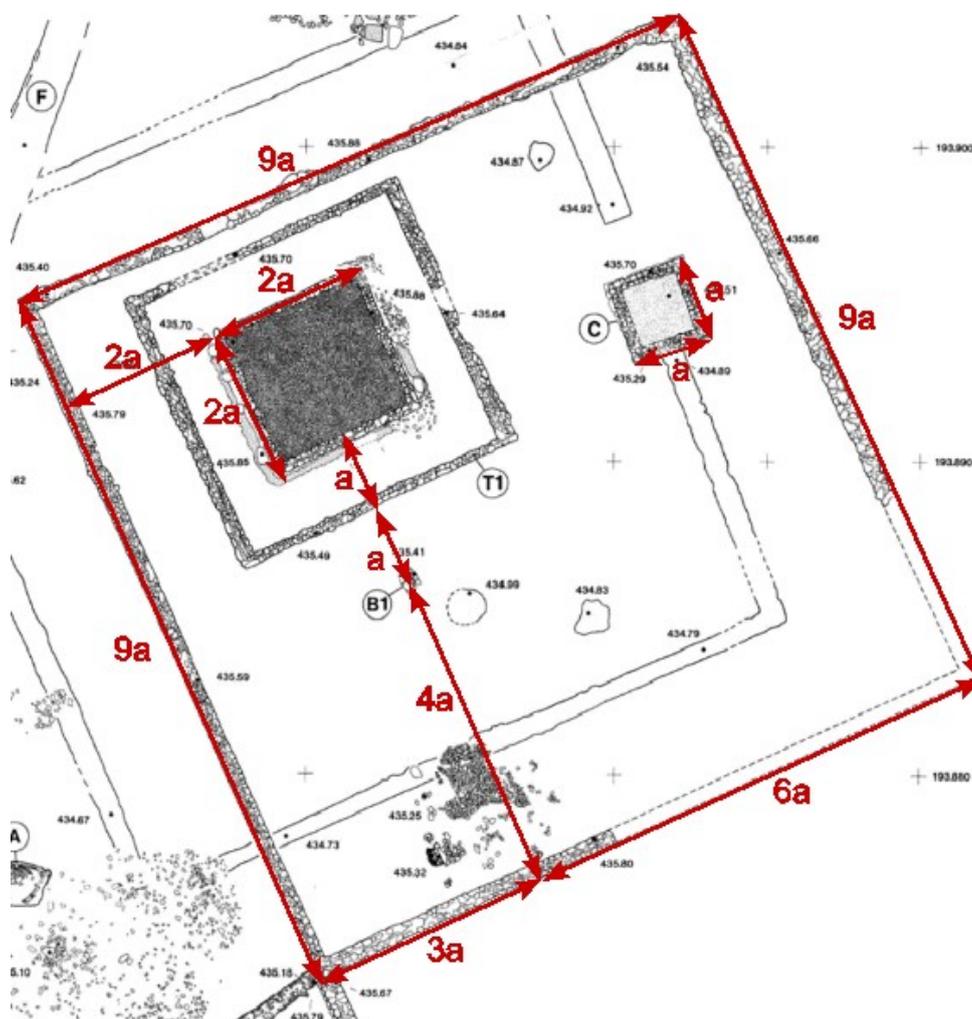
Plan du sanctuaire nord d'En-Chaplix à Avenches, avec explication des rapports modulaires (d'après le plan extrait de Castella et Flutsch 1990 p. 8)
